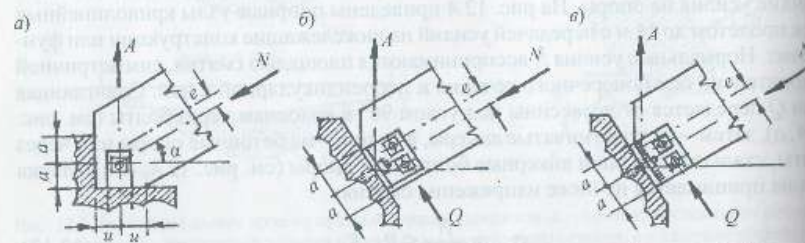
Варианты опорных узлов арок пролетом до 18 м из прямолинейных элементов: а – простейшее решение; б – решение с помощью уголков и анкерных болтов; в – решение с применением опорного башмака
